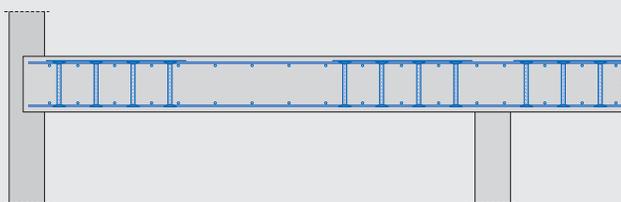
Арматура JDA для предотвращения продавливания перекрытий
